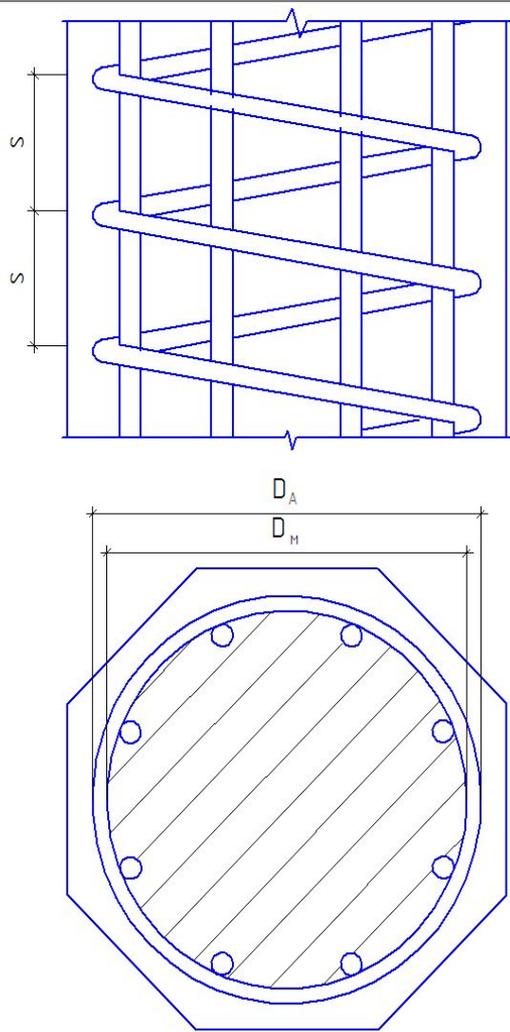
Схема армирования колонны поперечной арматурой в виде спирали
